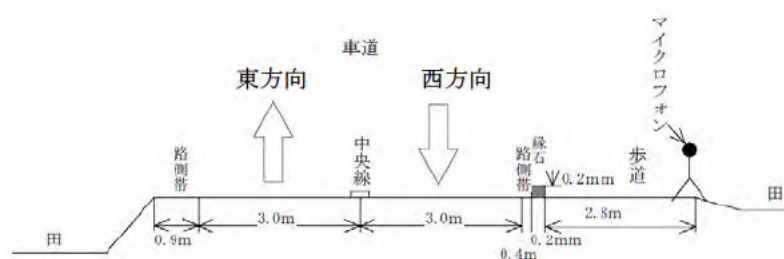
st. 4の詳細図及び道路断面図
